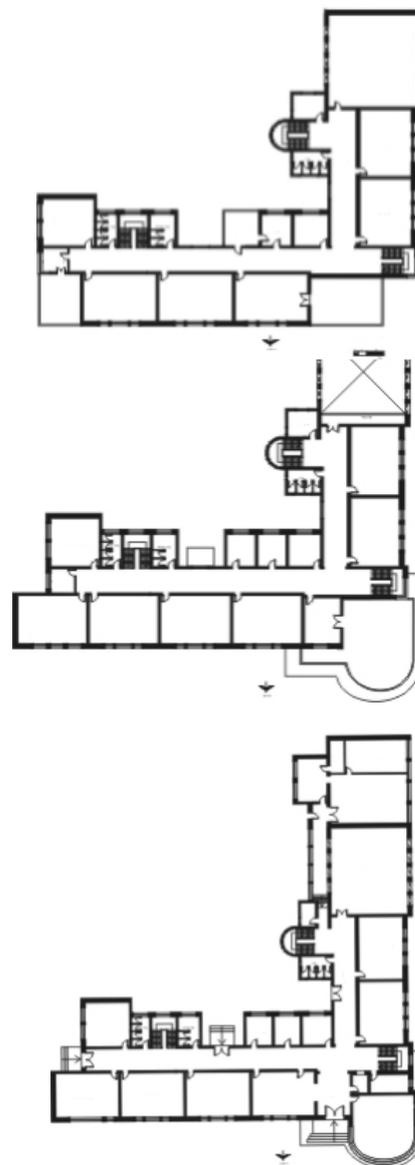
Grupo Escolar Silveira Martins (1940), de João B. Pianca. Plantas baixas.
